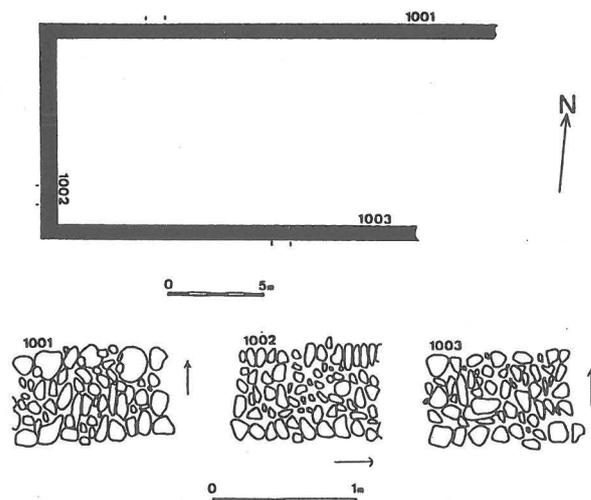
Plan et détails des mises en œuvre du bâtiment 1001.
